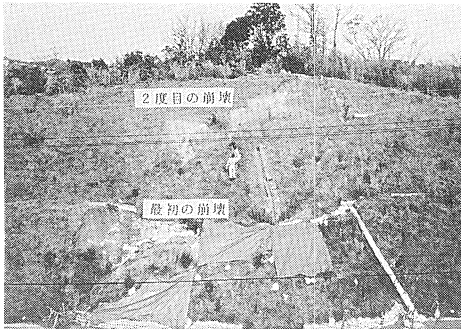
宇部（B）での斜面Ⅱの崩壊状況
